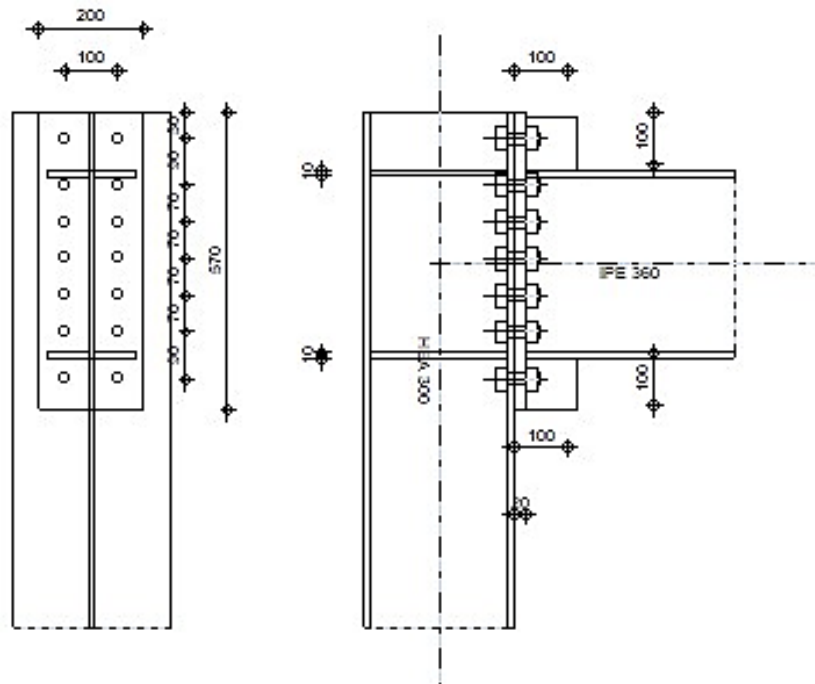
Détail de l'assemblage poutre principal poteau
